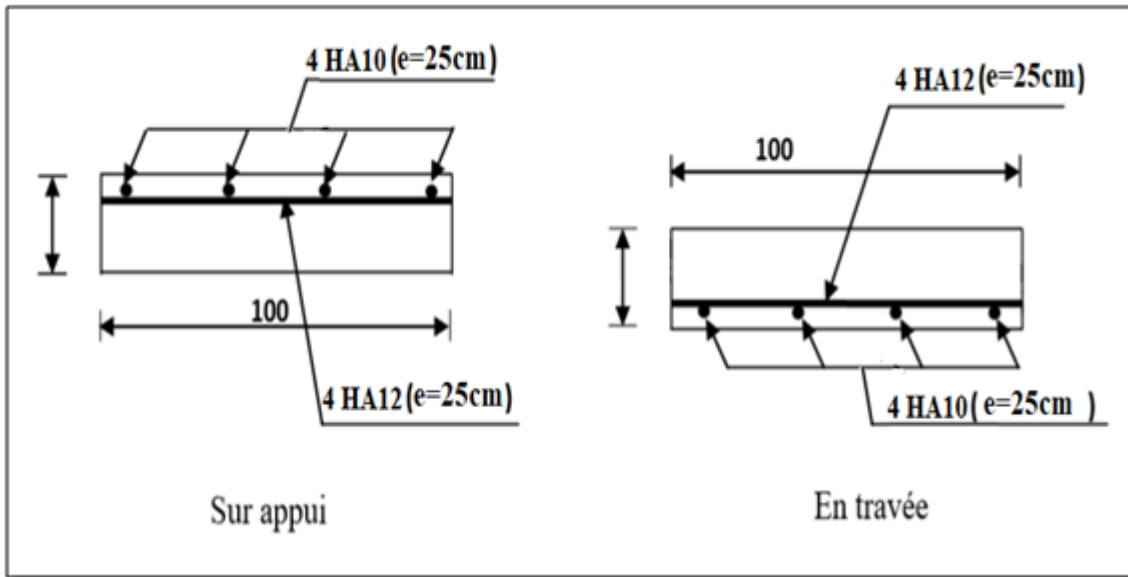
Ferrailage de l'escalier en travée et sur appuis
